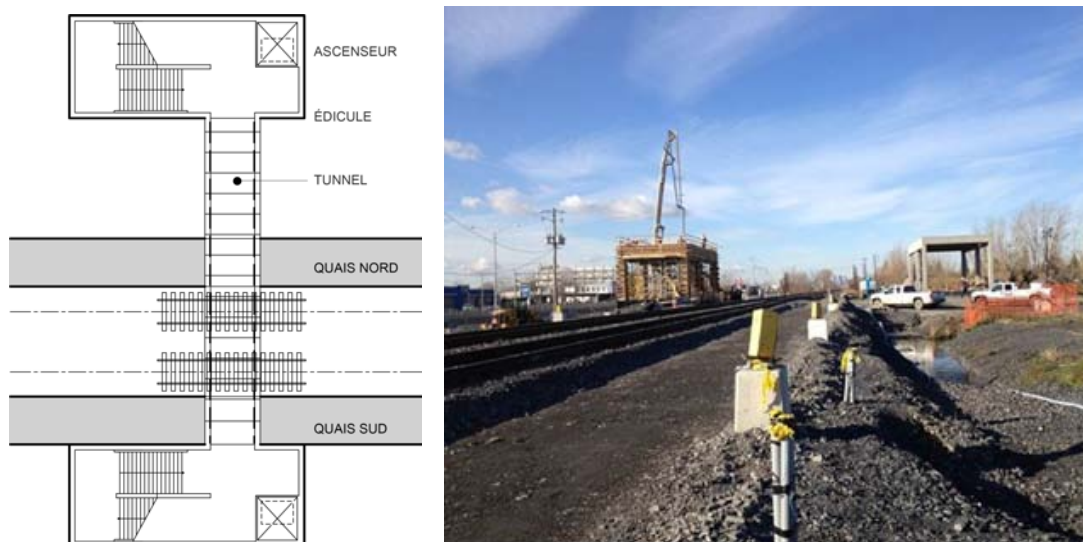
Gauche : Plan du lot 1 (Source : AMT, 2011). Droite : Photographie des édicules du lot 1 en construction (Source : Delisle-Boutin, 2012)
